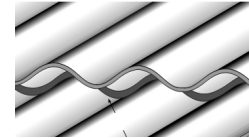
Exemple recouvrement transversal sur couverture fibres-ciment
